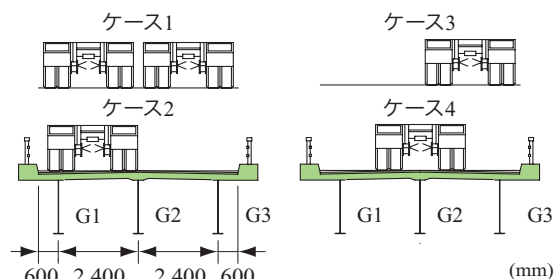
載荷ケース、計測断面位置およびひずみゲージ貼付位置
